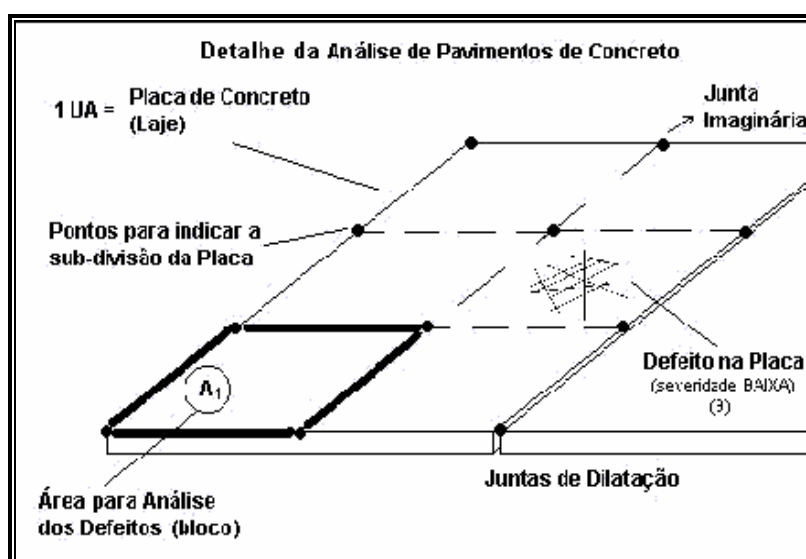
Detalhe da Análise de Pavimentos de Concreto
